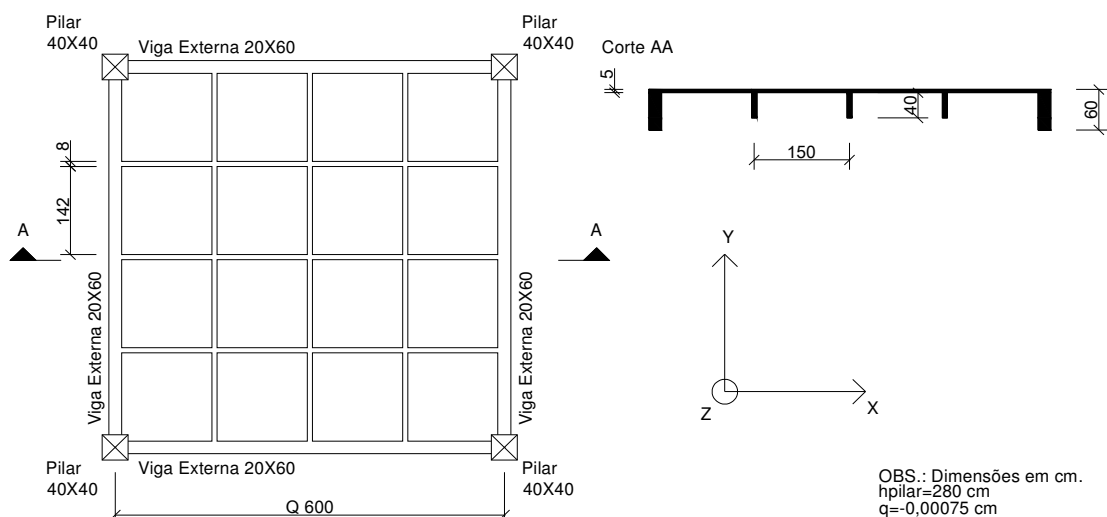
Desenho esquemático do pavimento 01 analisado n° de nervuras=3.
